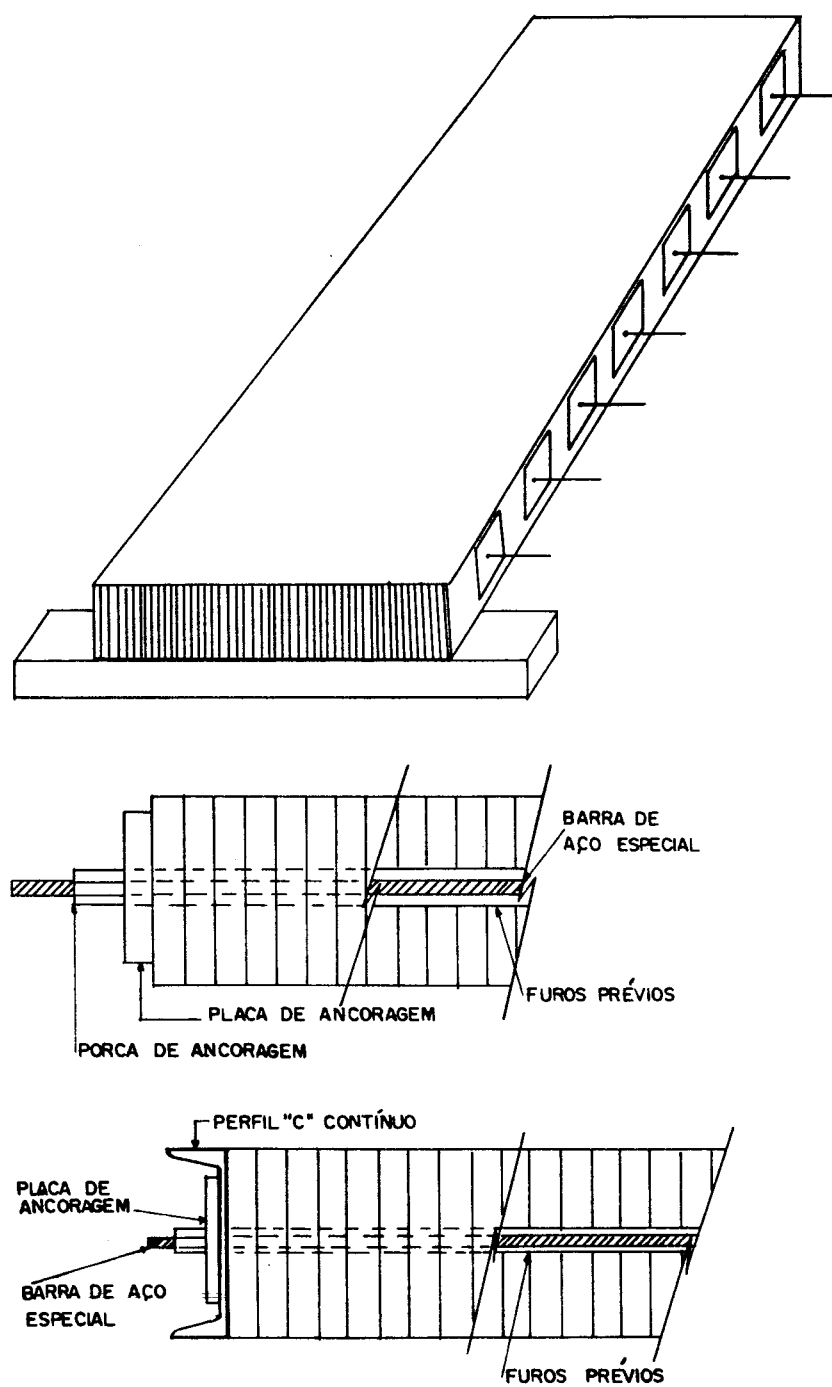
Tabuleiro FPL e suas configurações de ensaio (sem e com perfis "C").
